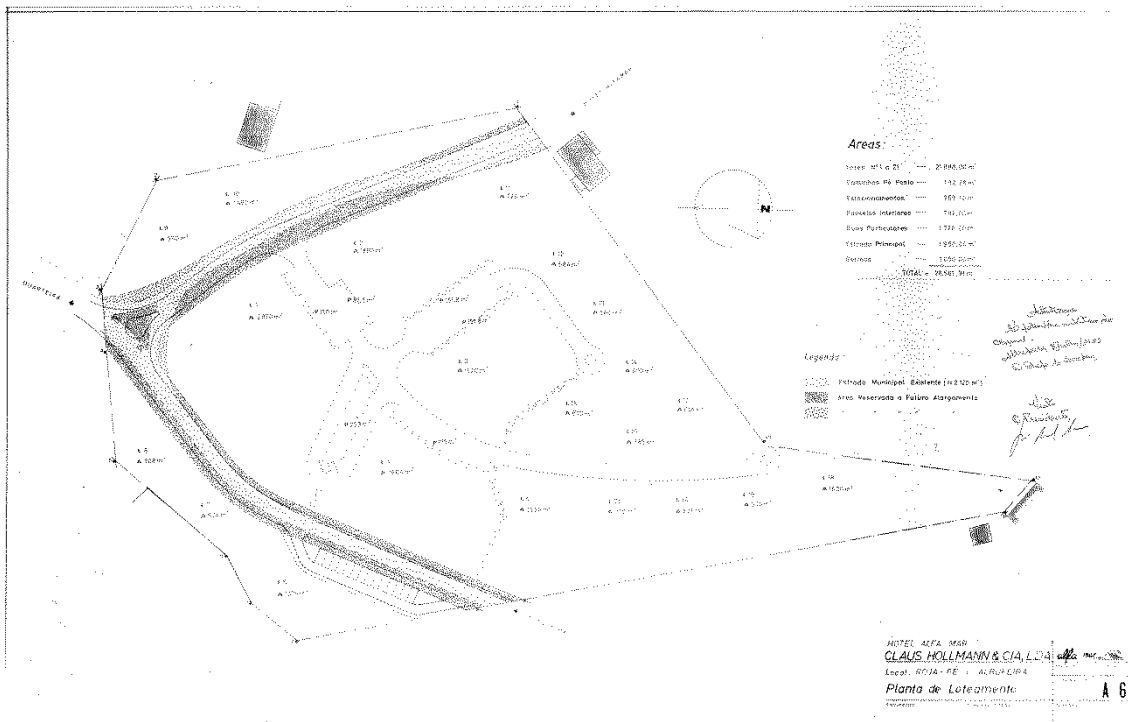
Planta do Alvará de Loteamento 9/82 – sem escala
